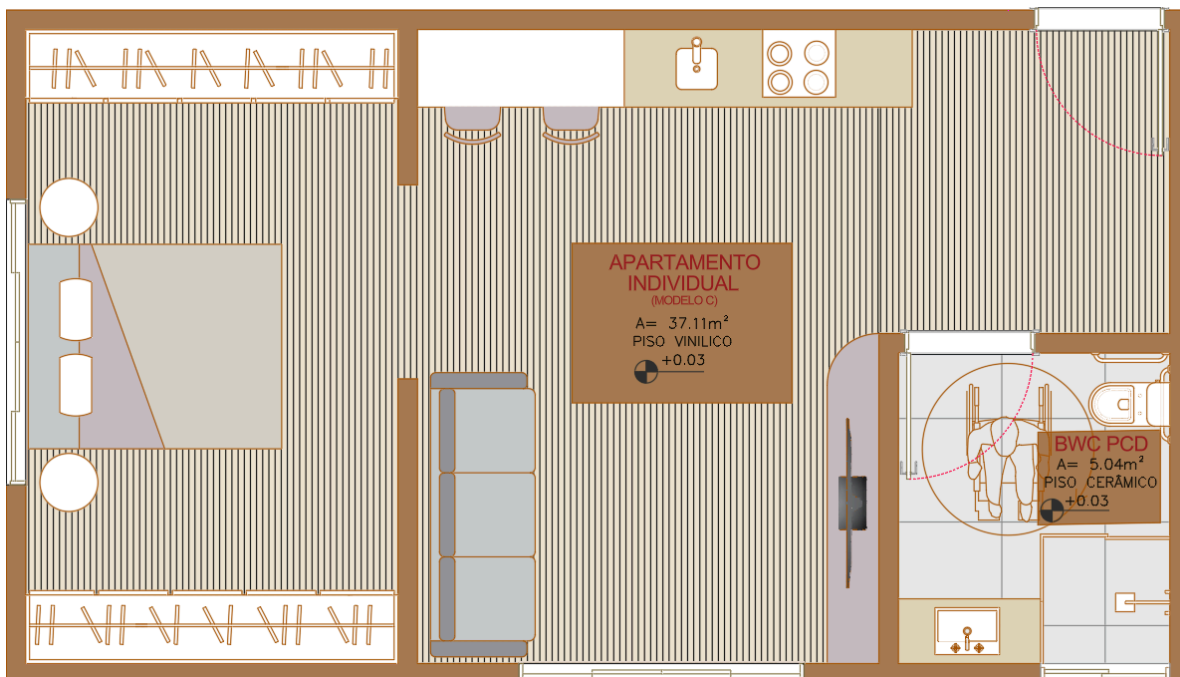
Imagem Planta de Layout do Apartamento Individual Modelo C.
